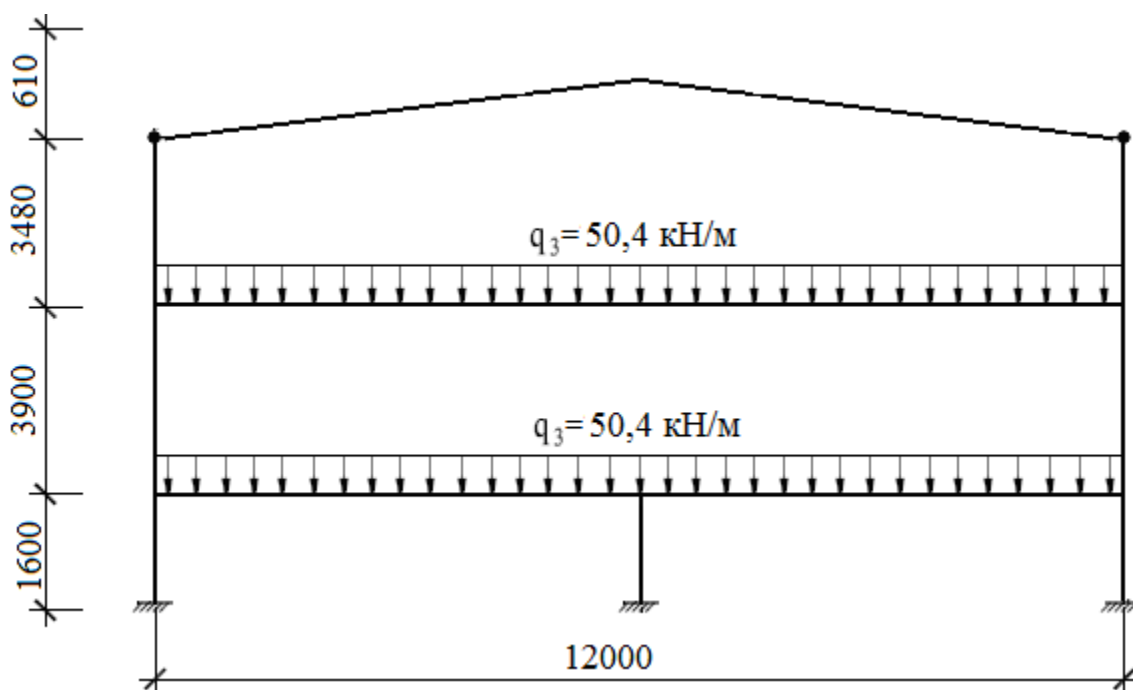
Кратковременная нагрузка на перекрытия
